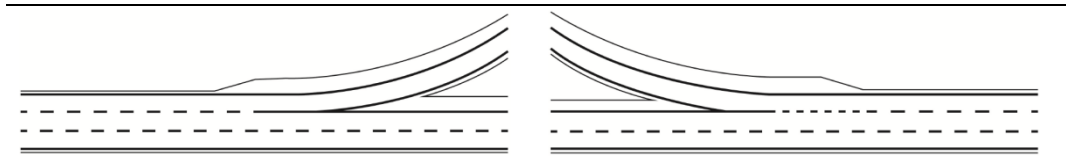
Markierung der Einfahrt (links) und Ausfahrt (rechts) im Anschlussbereich bei einer permanenten Pannestreifenumnutzung (PUN-Typ 1).
